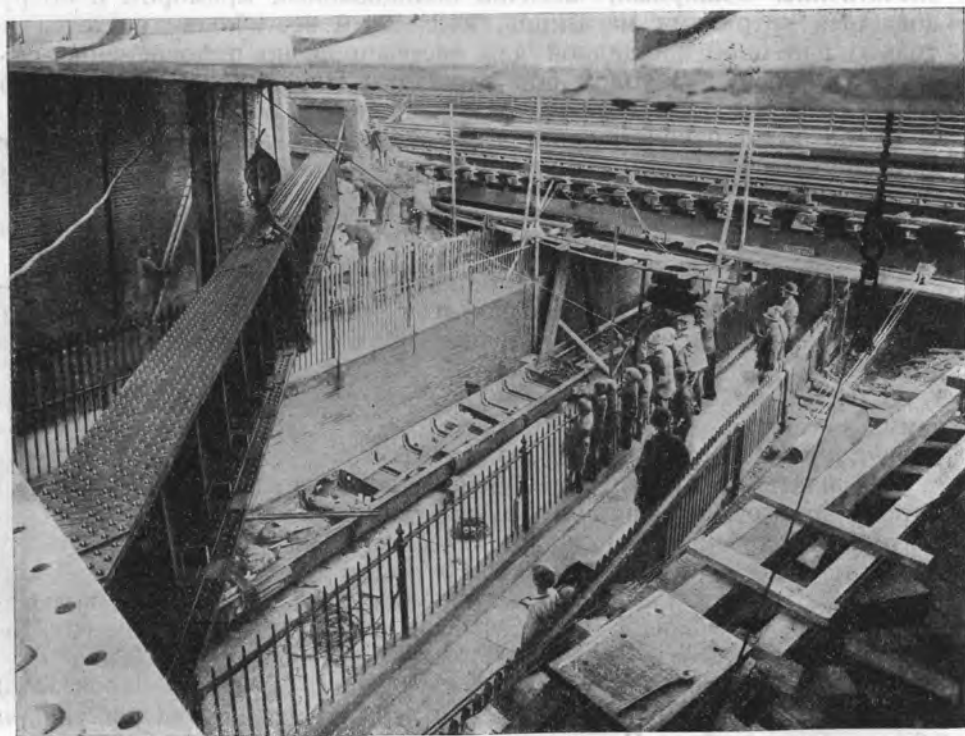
Заведение специальных балок несущего перекрытия подземного вестибюля.
